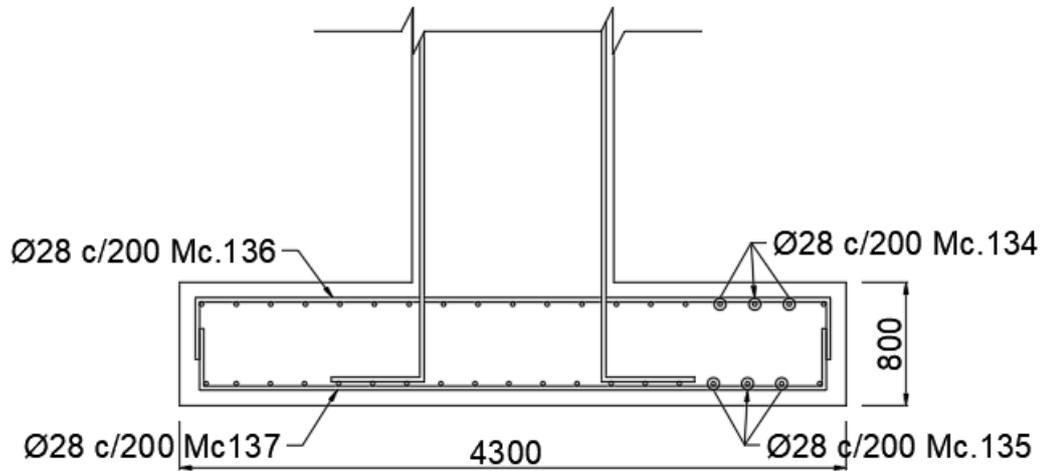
Sección transversal de la zapata, corte A-A´ [Elaboración propia]
